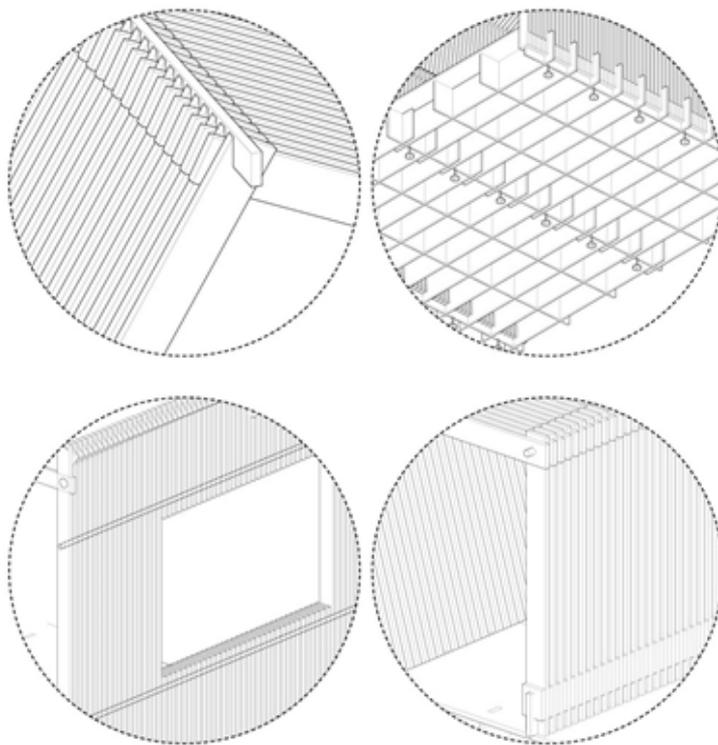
Detalhes construtivos da cumeeira e piso (acima), e aberturas laterais e mobiliário (abaixo)
